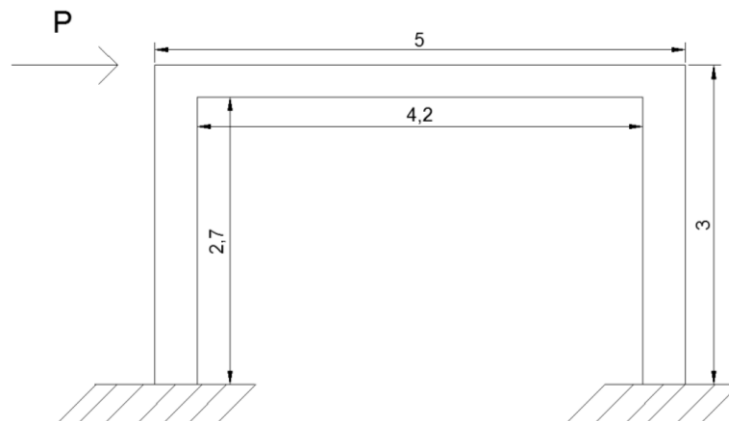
Pórtico de un piso calculado, cotas en m.
